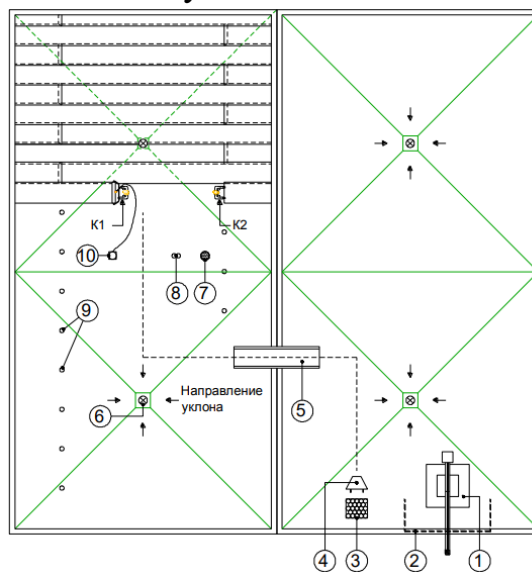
Схема организации рабочего места кровельщика: 1- кран крышевой; 2 – ограждение кровли; 3 – поддон с рулонным кровельным материалом; 4 – ручная тележка; 5 – трап; 6 – водоприёмная воронка; 7 – ведро; 8 – огнетушитель; 9 – рулонный кровельный материал; 10 – газовый баллон; K1, K2 - кровельщики
